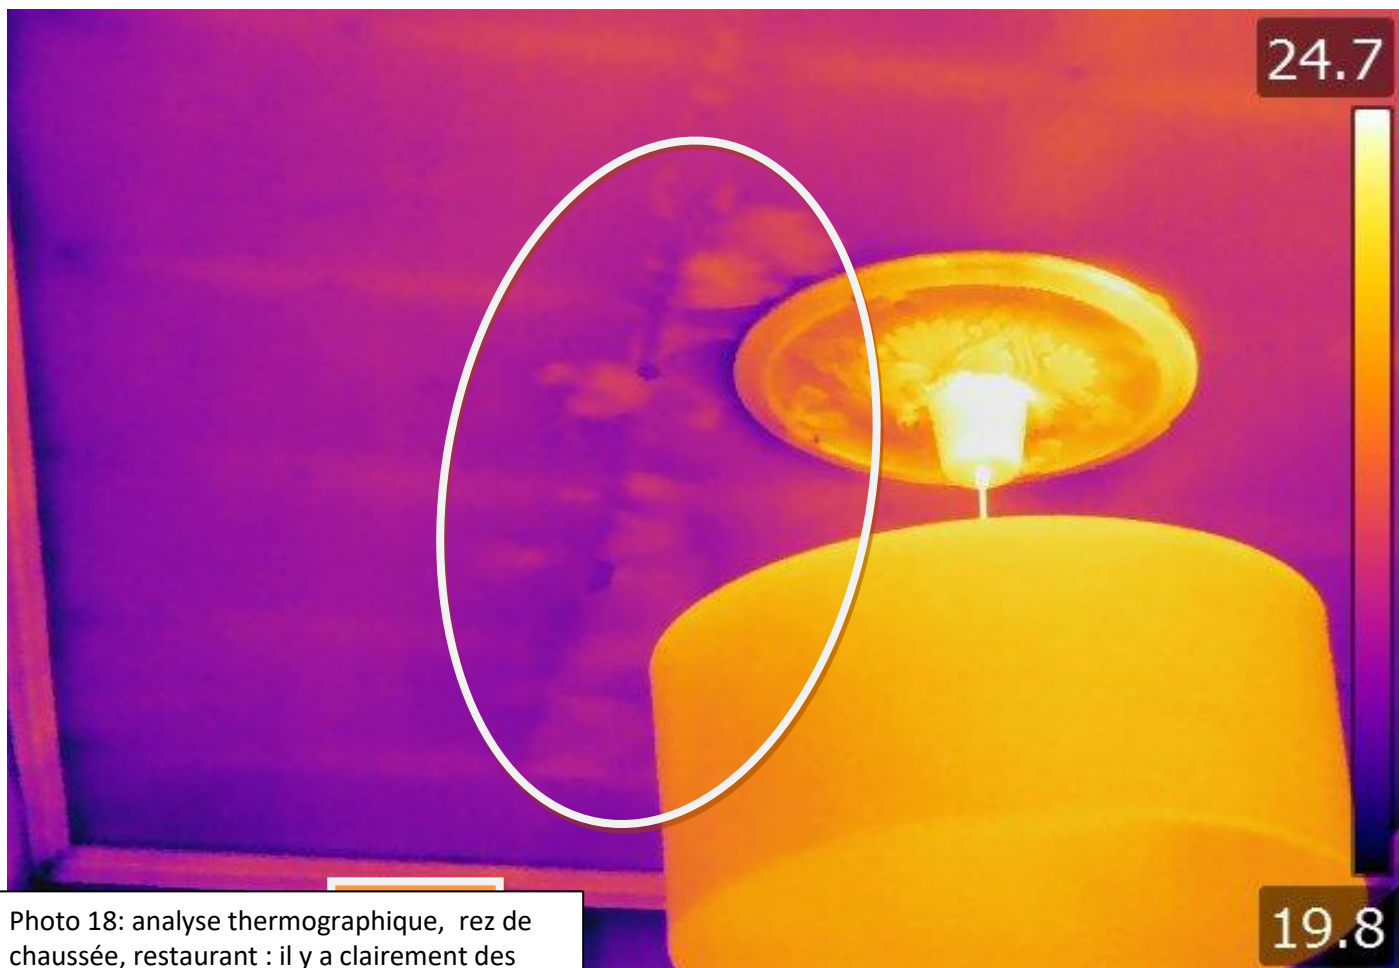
analyse thermographique, rez de chaussée, restaurant : il y a clairement des infiltrations d'eau dans le plafond à la zone endommagée
